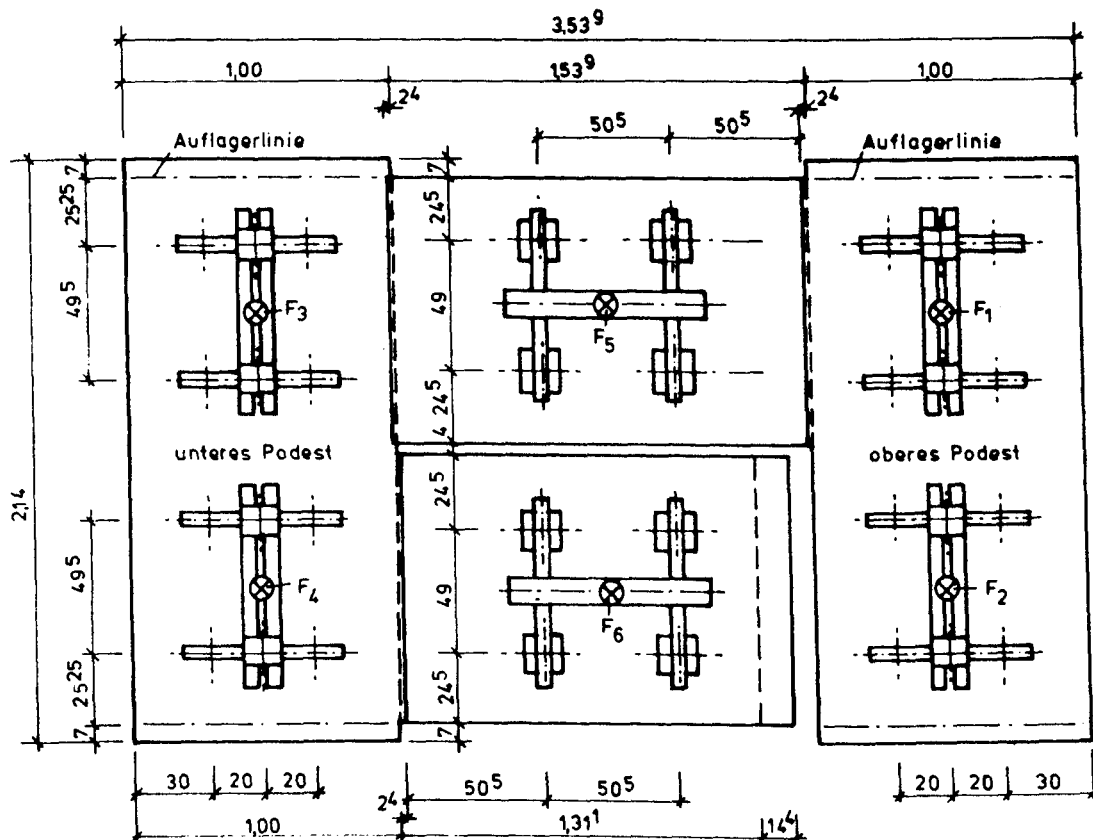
Grundriß des Versuchskörpers und der Verteilungsträger für die Belastung
